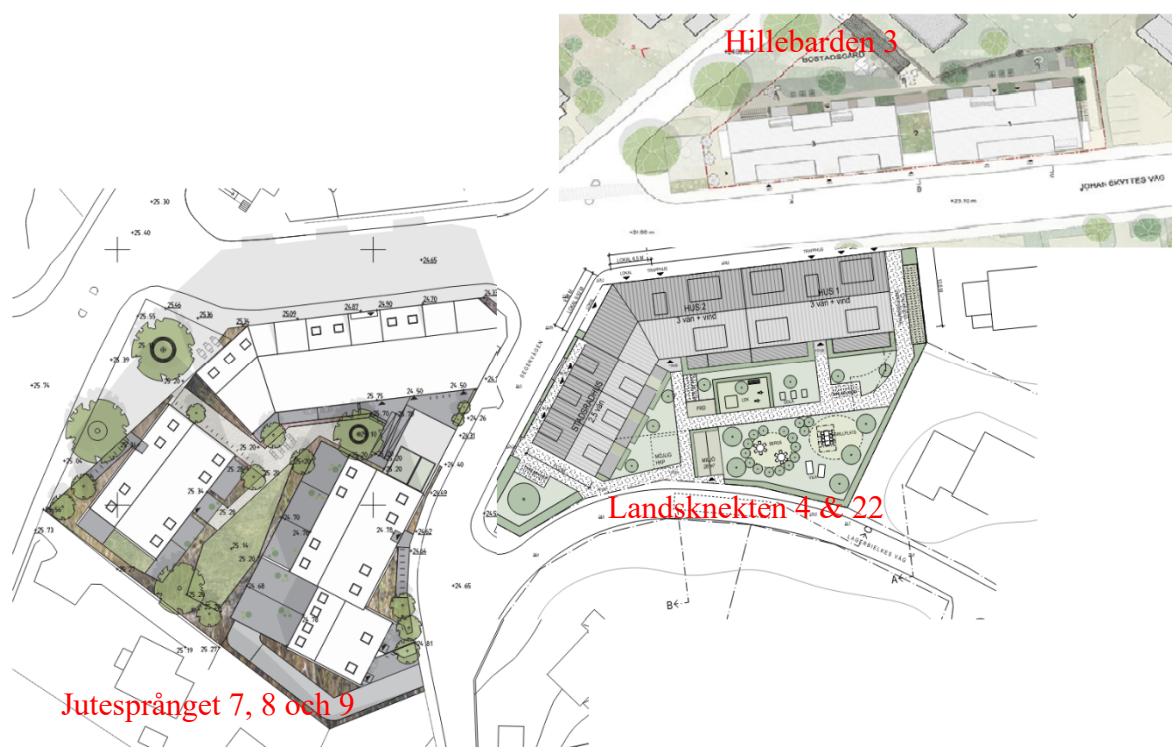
Urklipp ur situationsplan, tänkt utformning och orientering för planerade bostäder
